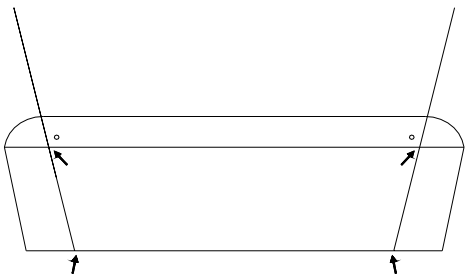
et B.6.2.2 Installation d'une unité complète sur le toit
